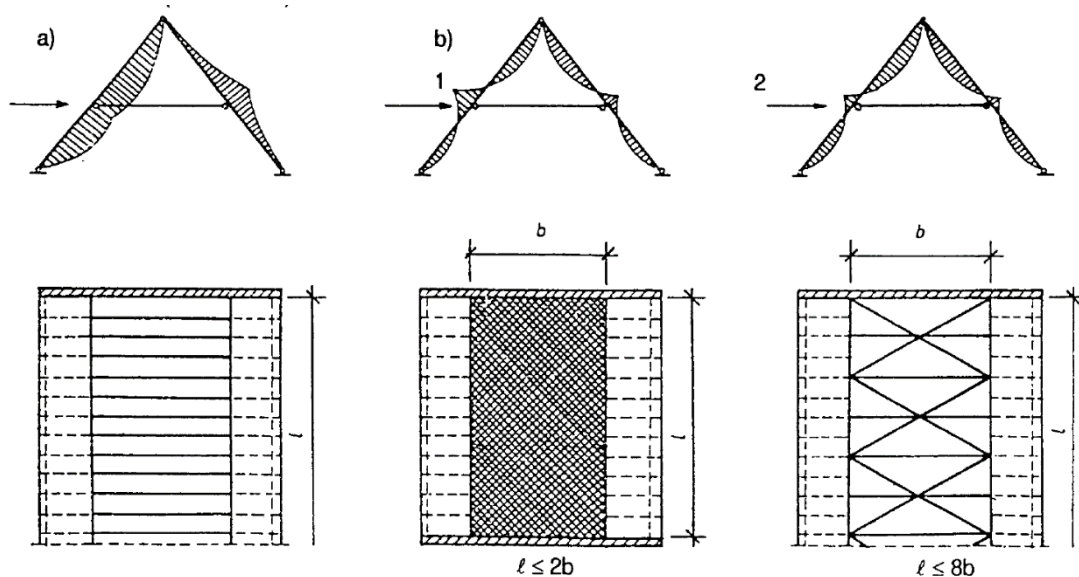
Schematické uspořádání krovu krokevní soustavy
